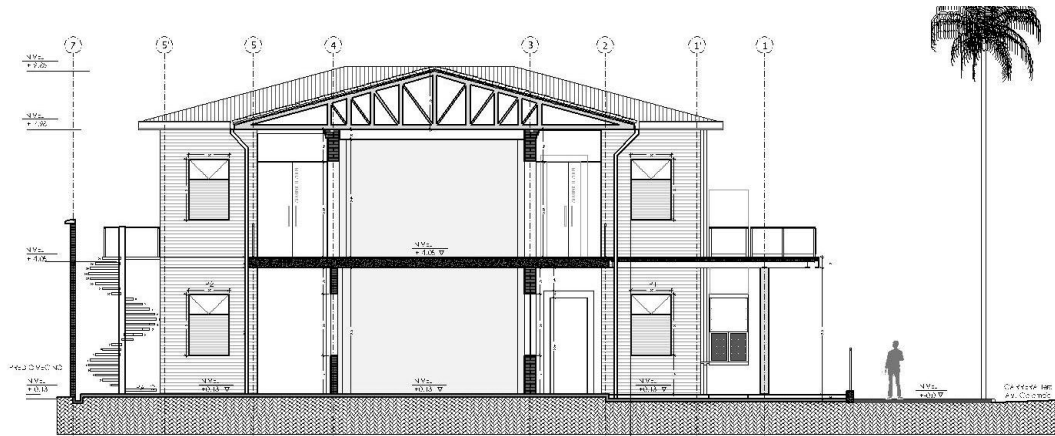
Edificio Biblioteca del Centenario. Sección longitudinal.
